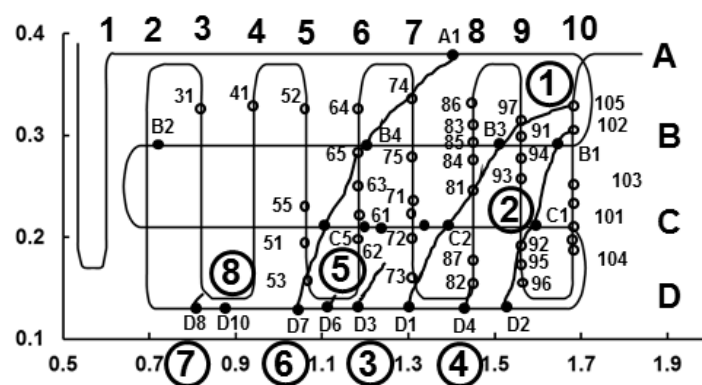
Identificación de fisuras que conforman el patrón de fisuración de la viga I-3
